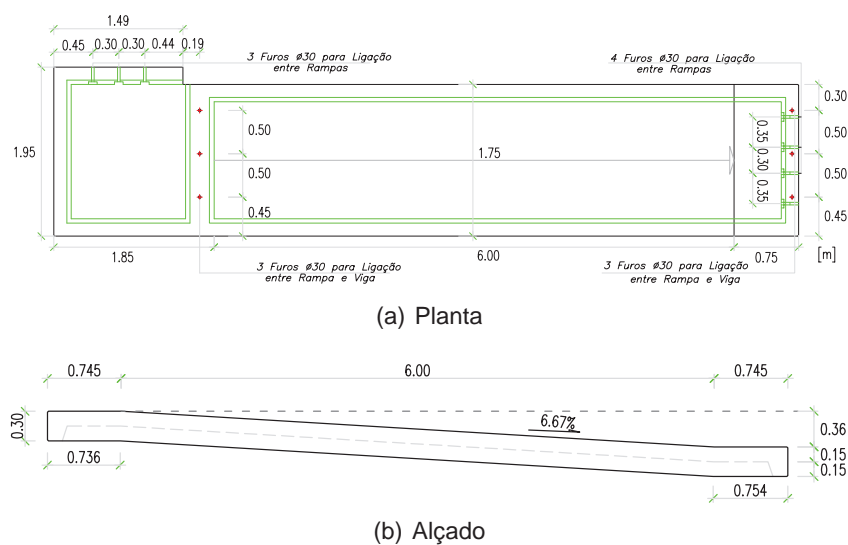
Pormenor da rampa com patamar tipo em planta e em alçado [62]
